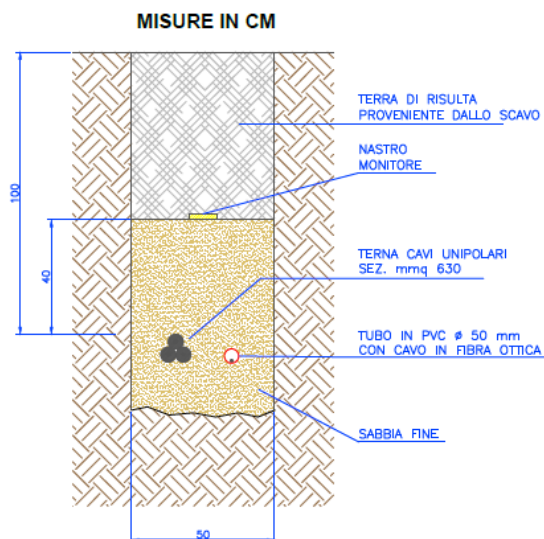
Sezione tipo cavidotto con terna di cavi unipolari su terreno agricolo
